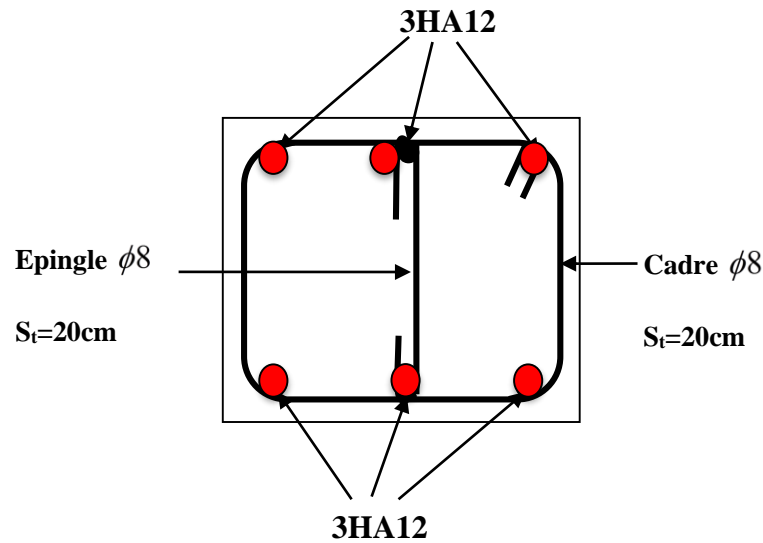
Schéma de ferrailage de la poutre de chaînage.
